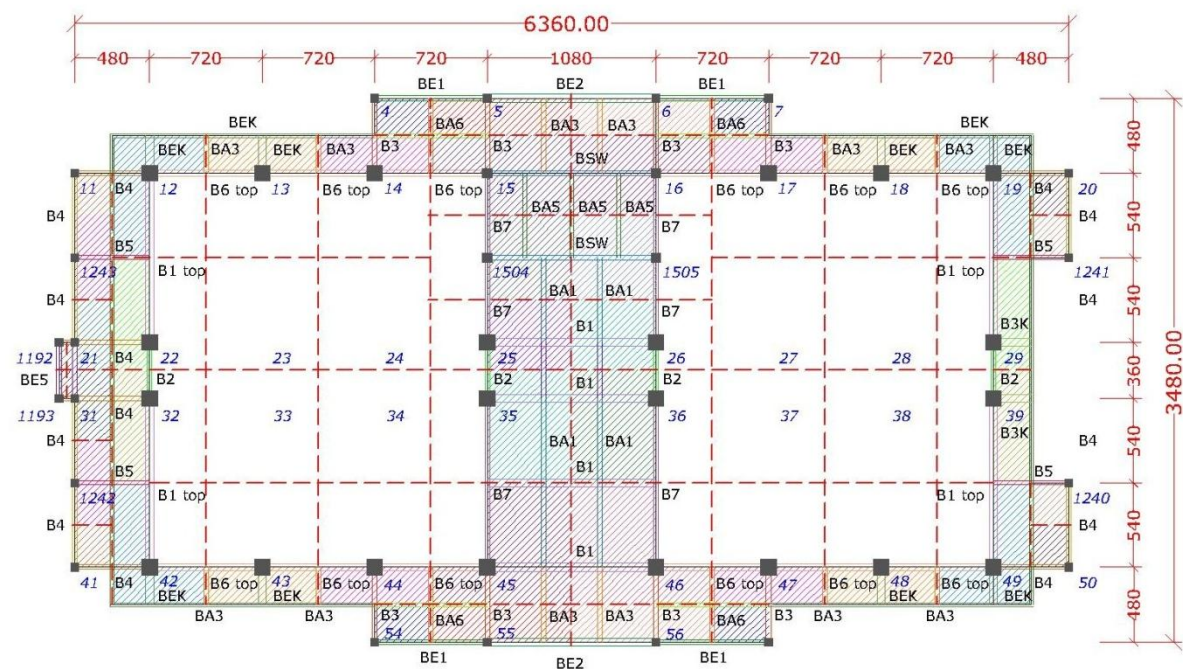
Tributary area kolom untuk beban balok pada lantai 3 hingga lantai 7
